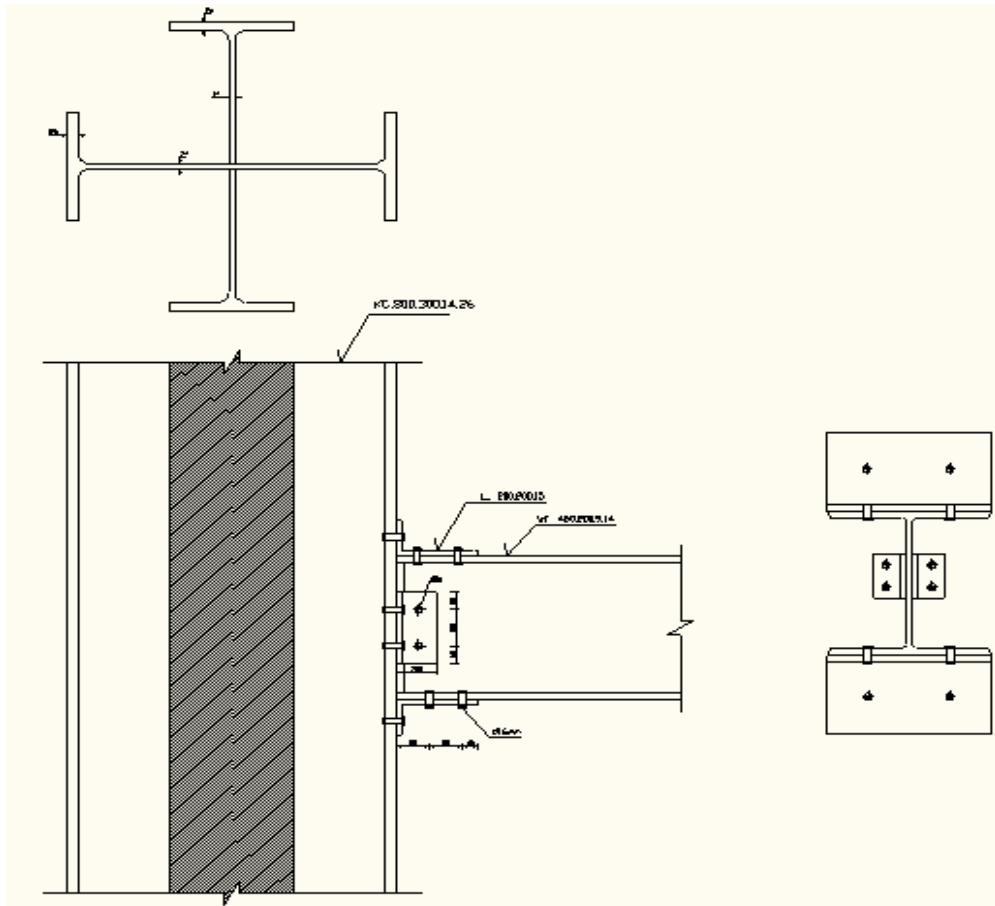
Desain Sambungan Balok–Kolom dan Balok – Bresing potongan 1
